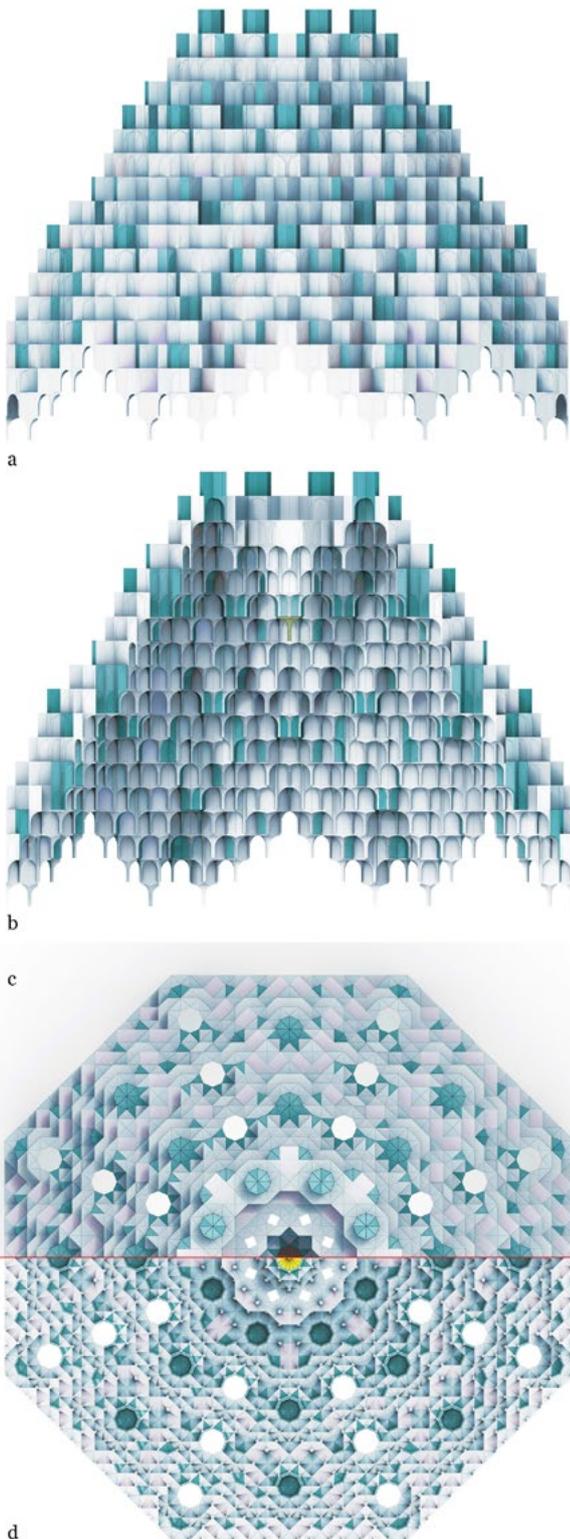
Alzado (a), sección (b), semi-planta de trasdós (c) y semi-planta de intradós (d) de los mocárabes de la ochava.
